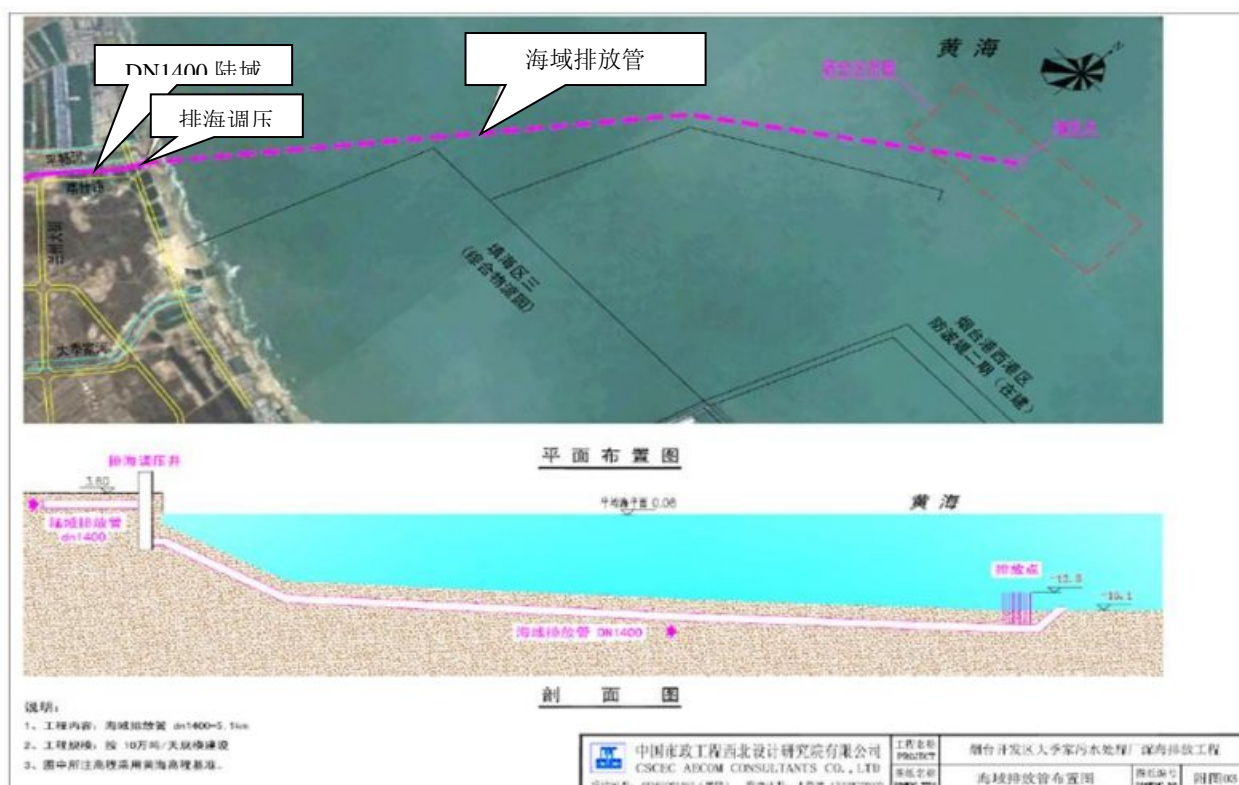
新城污水处理厂排海管线工程平面布置图
